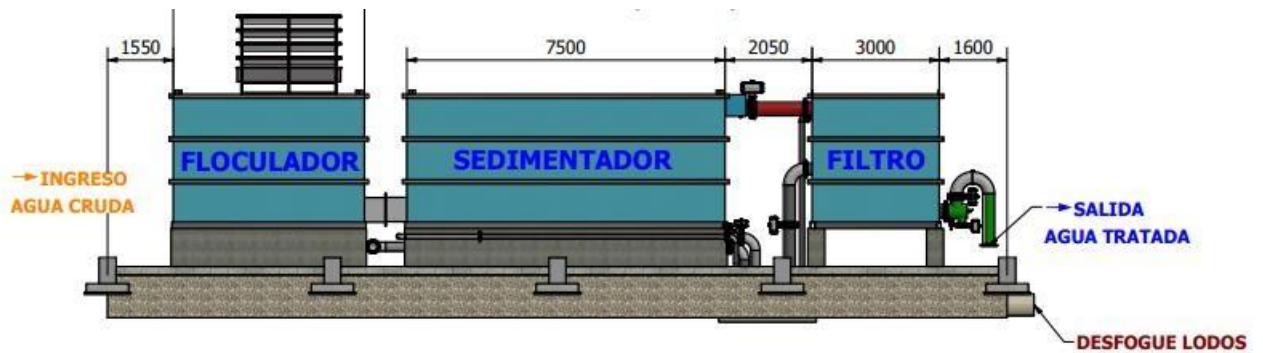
Vista en corte, planta de tratamiento modular 3D
